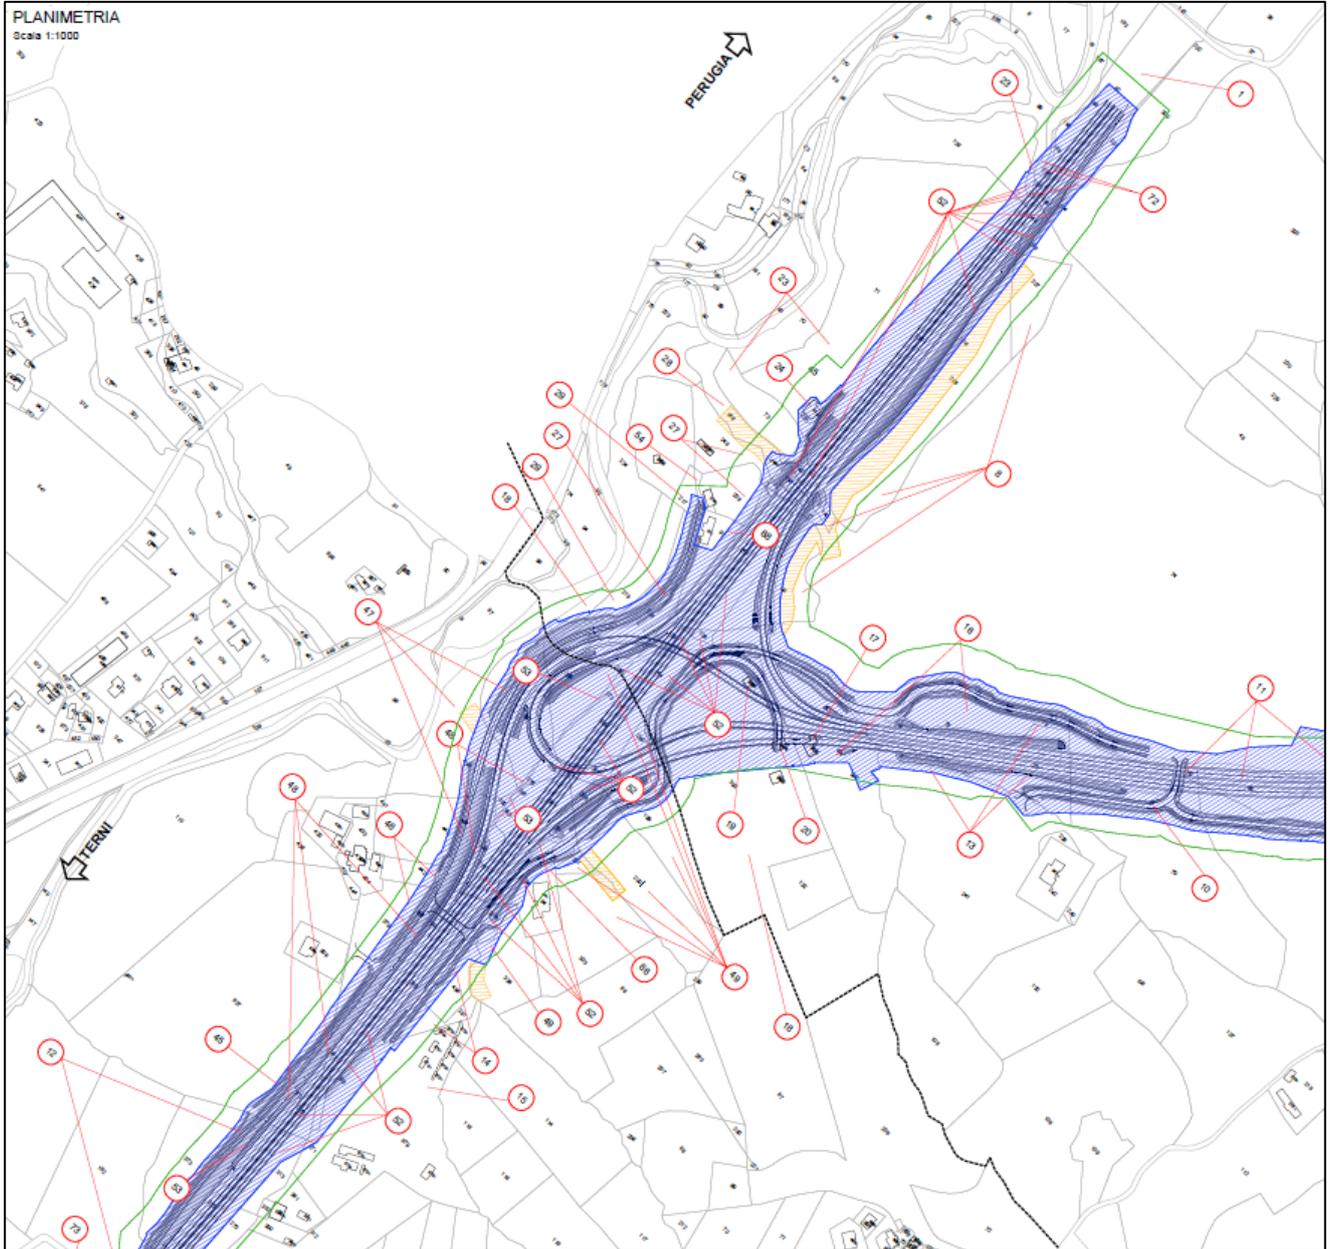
Estratto planimetrico della tav T00ES00ESPPP01
